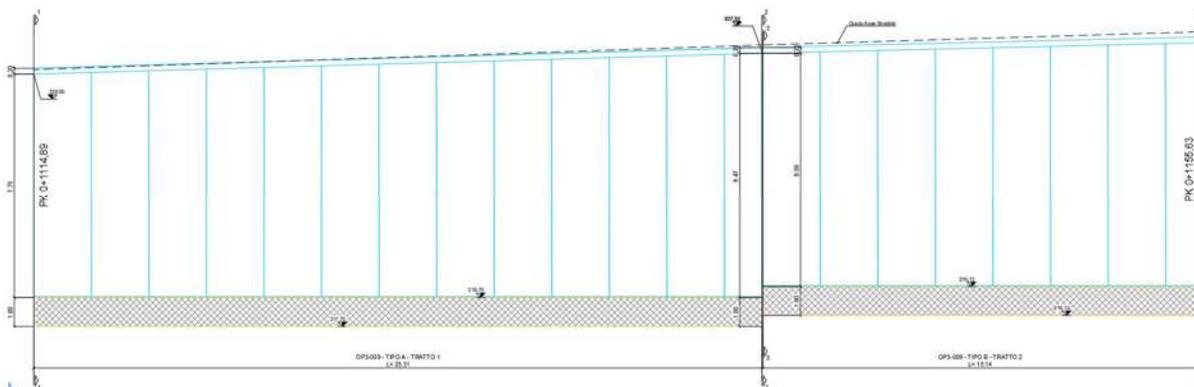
Muro OP3-009 – Stralcio prospetto
